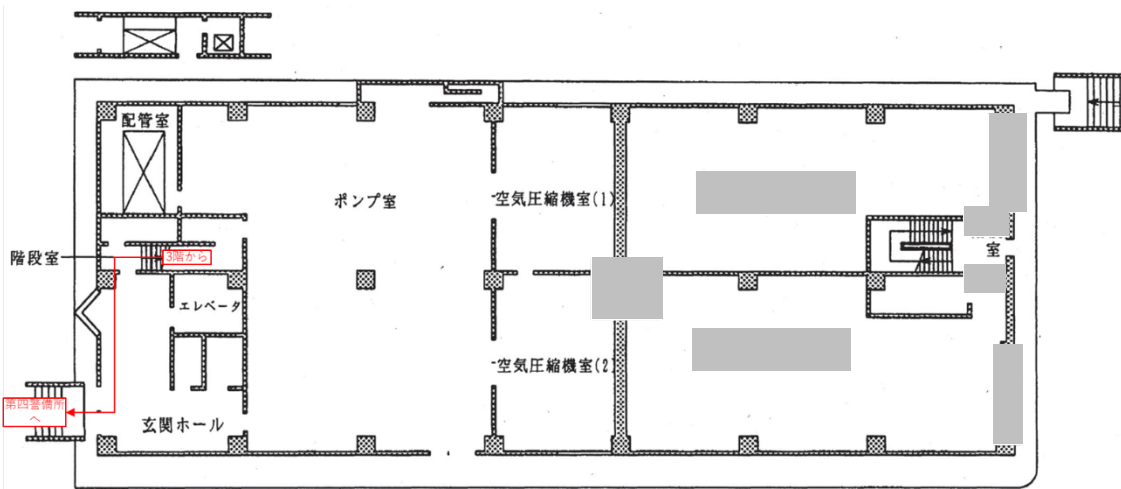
(2) 移動経路 (ユーティリティ施設 地上1F 平面図)
